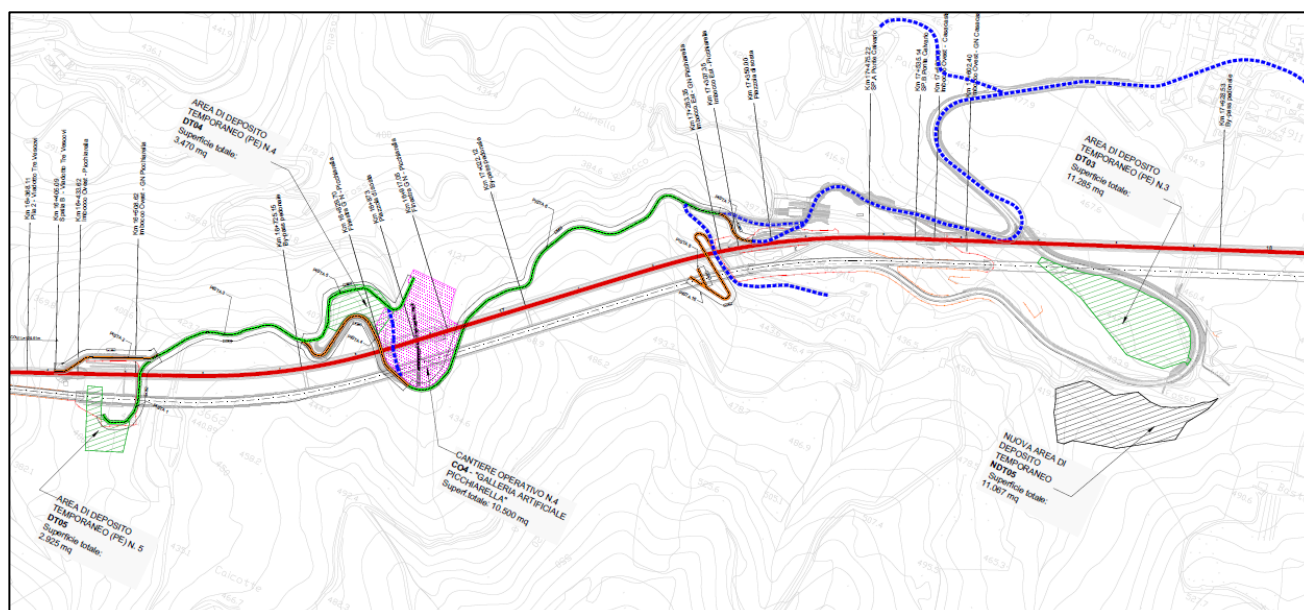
Stralcio planimetrico con individuazione delle aree di stoccaggio e deposito intermedio
